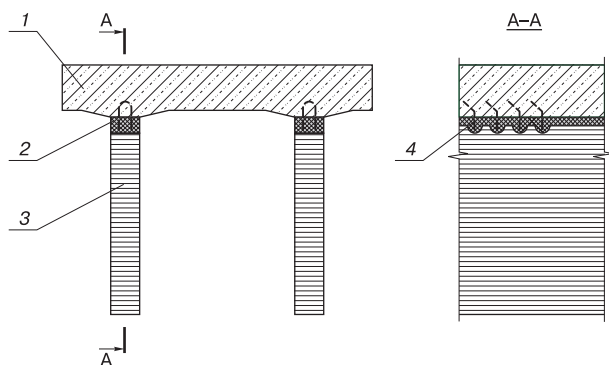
Схема дерево-полимер-бетонной конструкции для автодорожных мостов: 1 – сборная или монолитная железобетонная плита; 2 – каутон; 3 – дощатоклеенная балка; 4 – металлические анкеры
